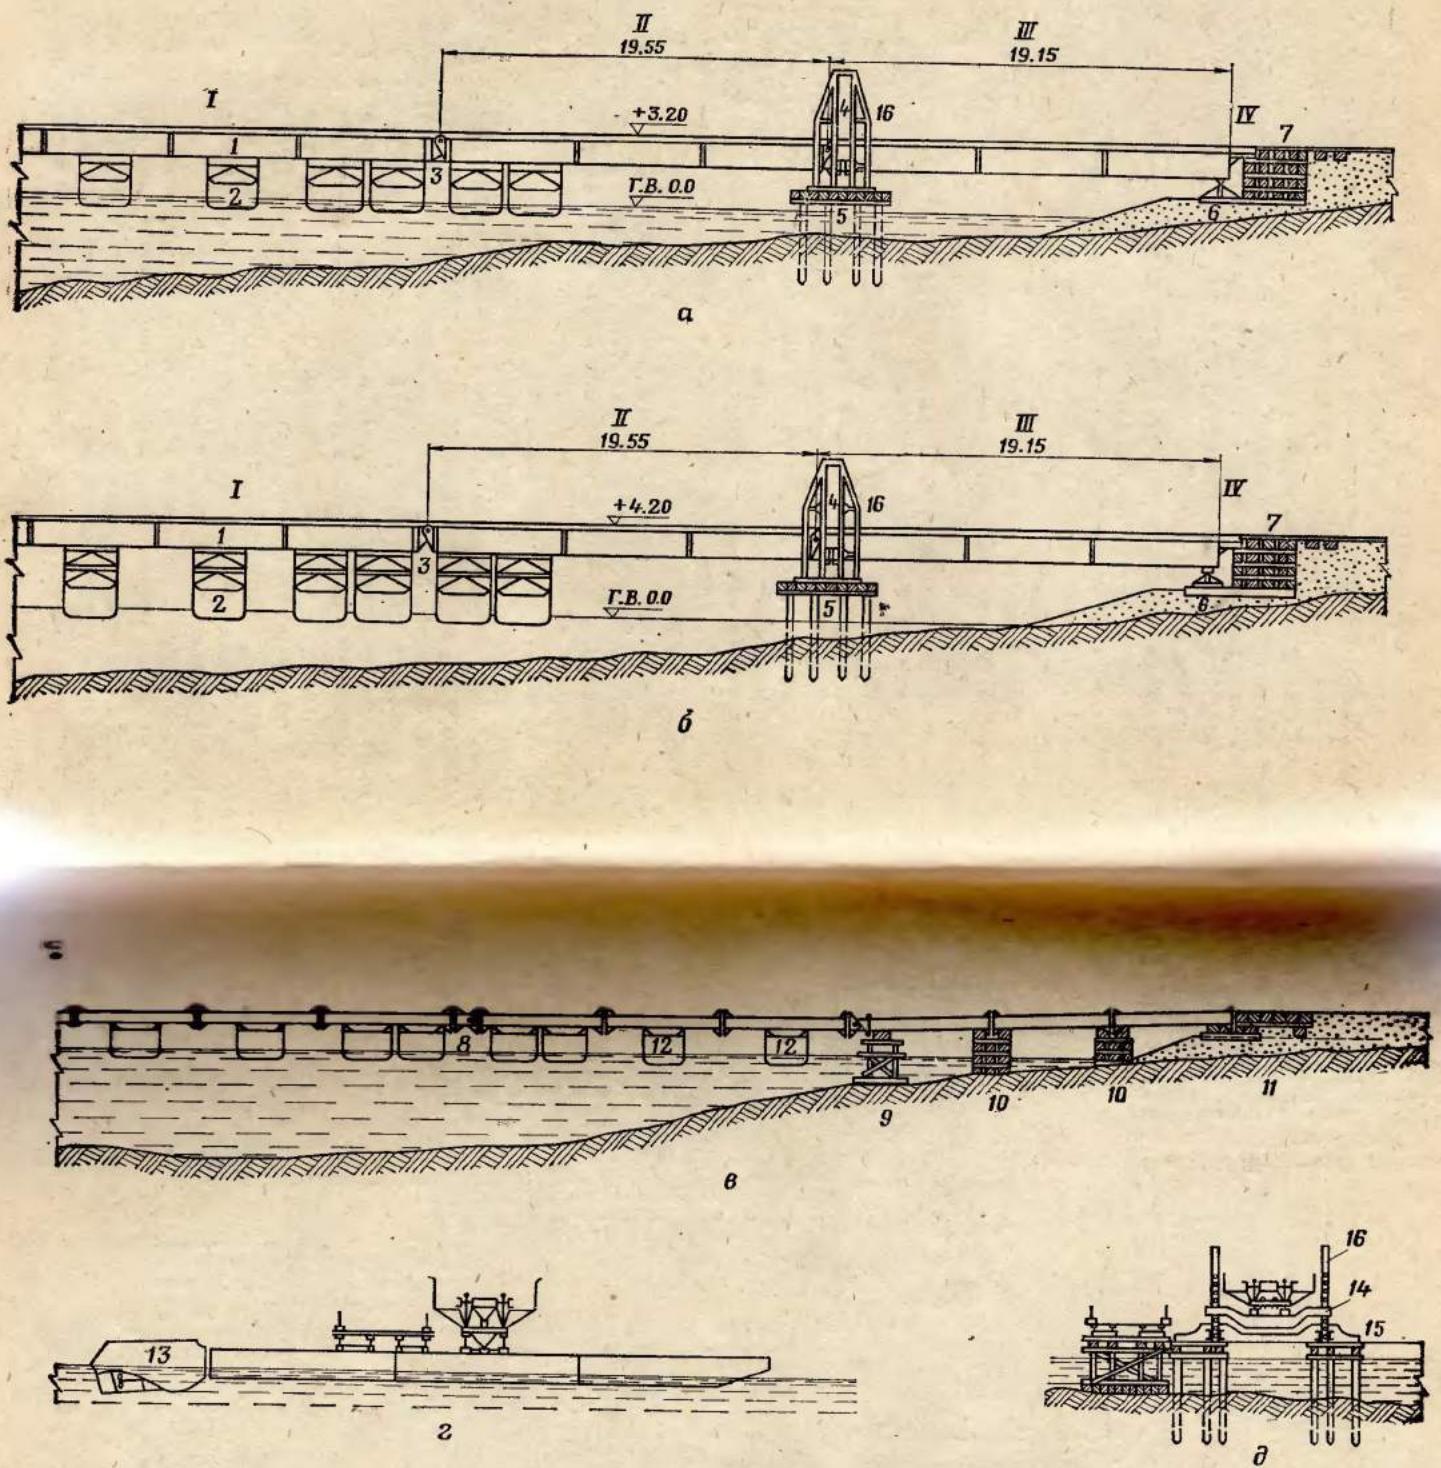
Схема береговой части с подъемной рамной опорой на свайном фундаменте и береговой частью автопроезда на рамных и клеточных опорах:
